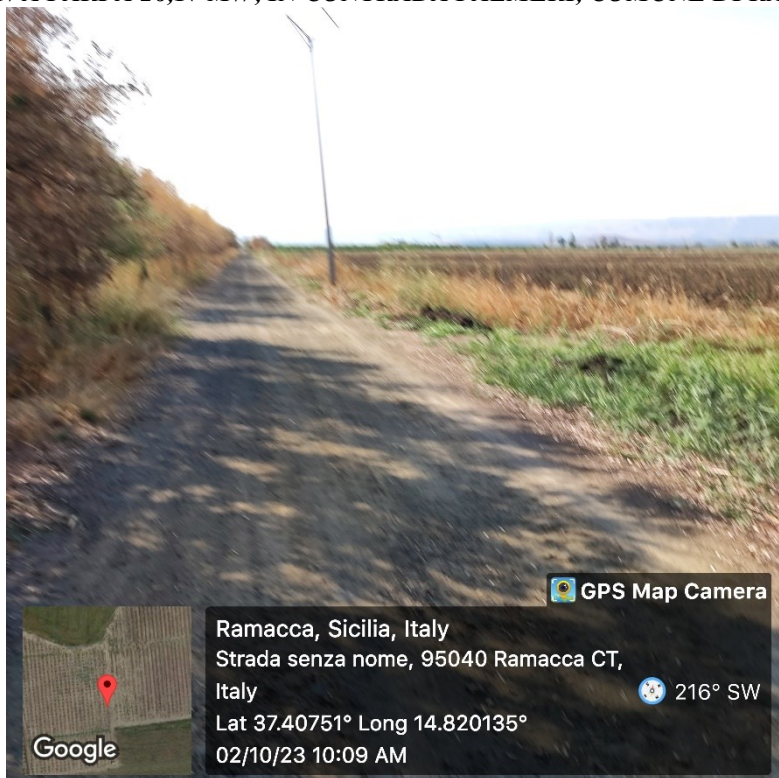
cavidotto lungo la strada vicinale che collega il lotto 1 e il lotto 2
